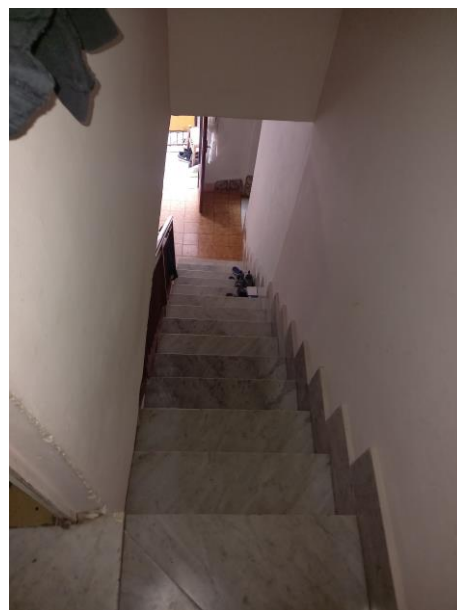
rampa scala P.T./P. 1°- rampa scala P.1°/P.2°
